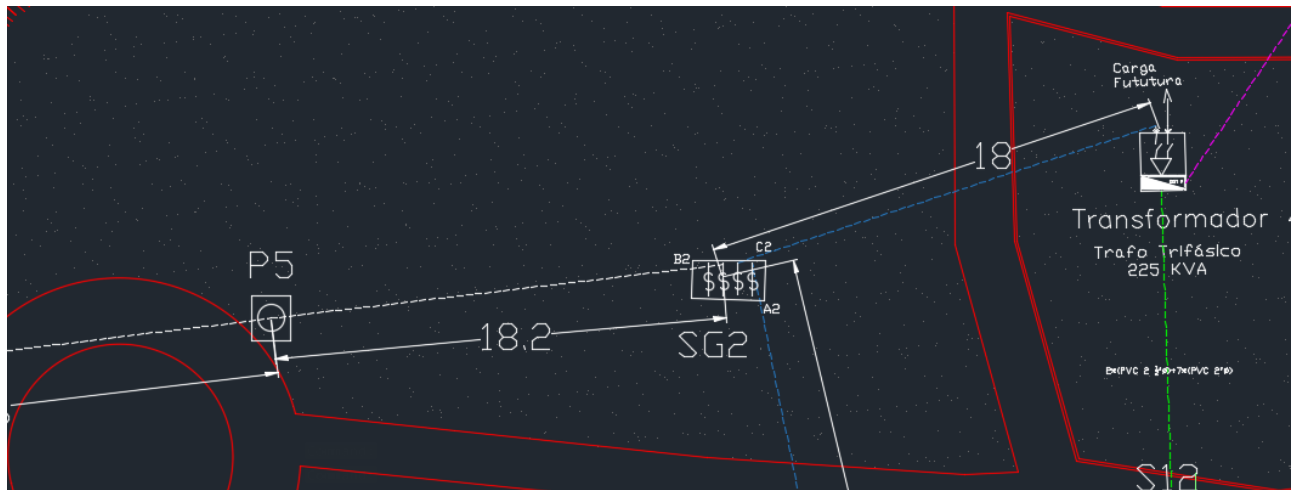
Captura del plano del punto en el sitio donde se ubicará el switchgear 2.
